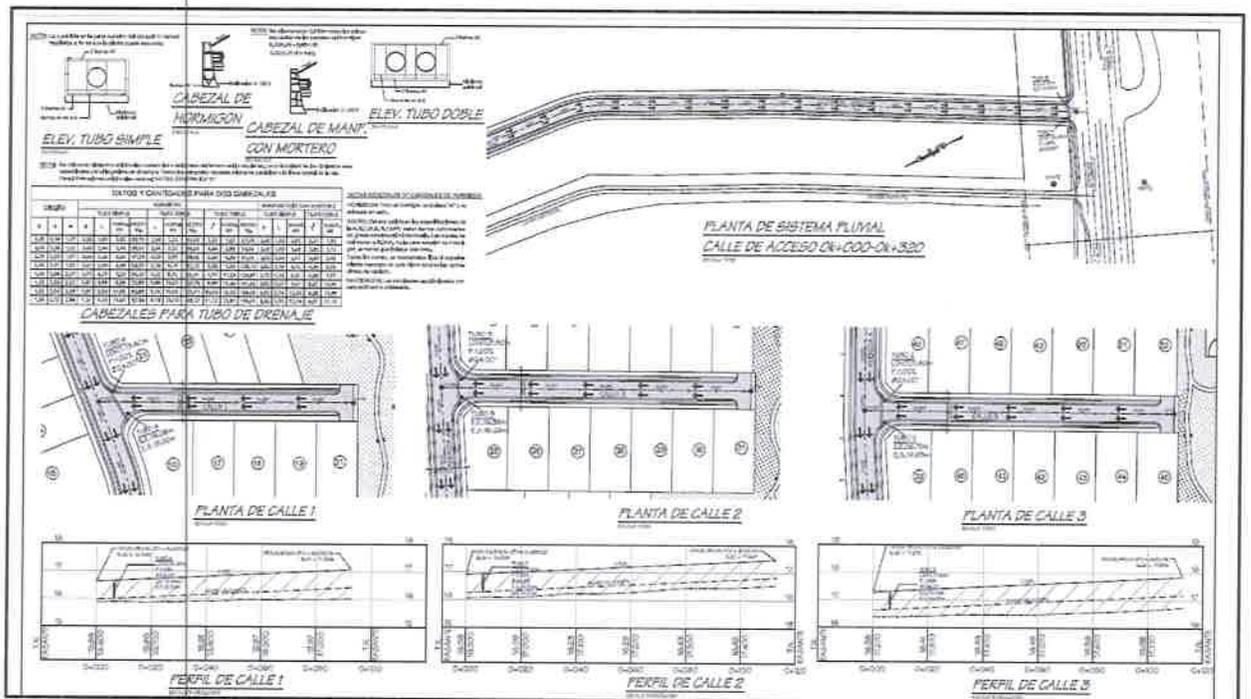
Fuente: detalle extraído de la hoja de plano 12 de 19 – Planta del Sistema Pluvial del Proyecto Residencial Santa Rita.
